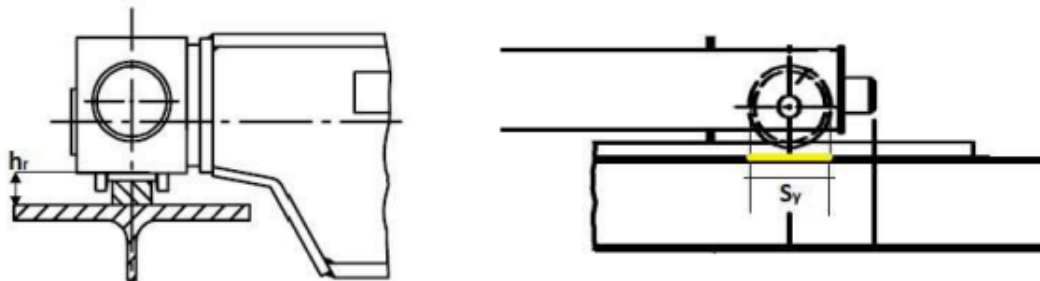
Illustration des galets sur la poutre de roulement .
